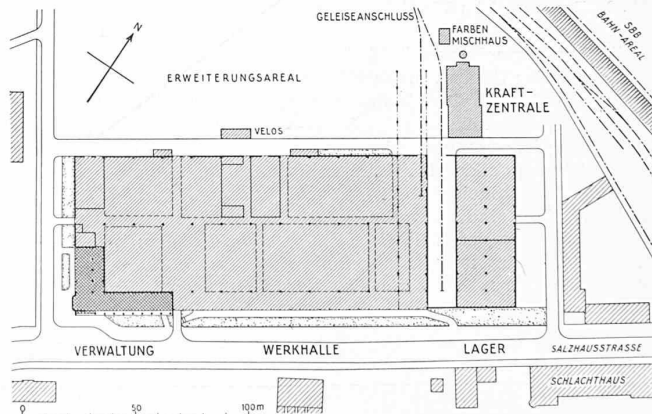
Lageplan des ganzen Werkes. — Masstab 1:3000
